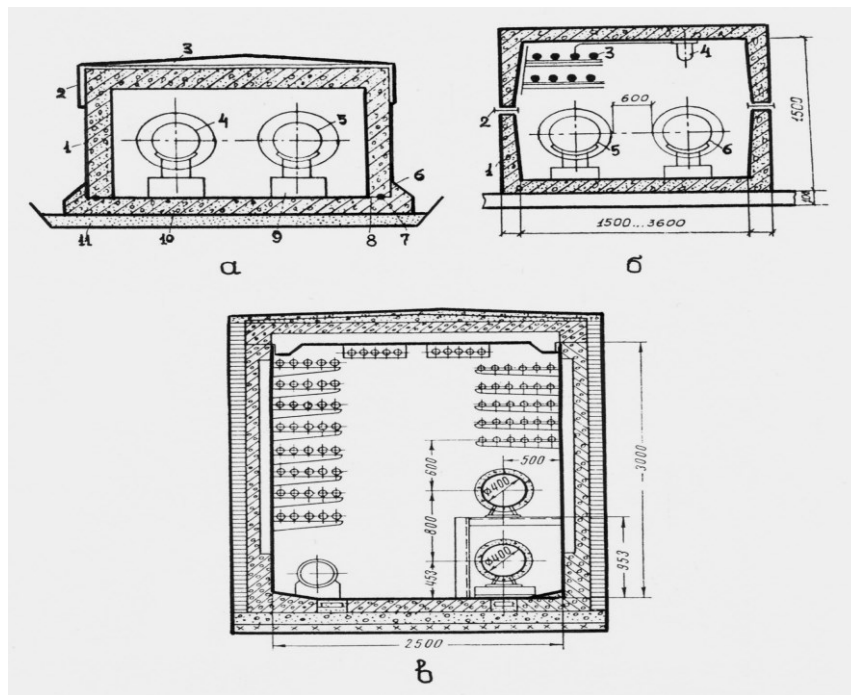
Підземне прокладання теплопроводів: а – у непрохідних каналах: 1 – залізобетонна секція; 2 – гідроізоляція; 3 – захисна стяжка з цементного розчину; 4, 5 – подавальний і зворотний трубопроводи; 6 – бетон; 7 - пароніт; 8 – ізольна мастика; 9 – опорна подушка; 10 – плита; 11 – піщана підготовка або бетон марки 50; б – у напівпрохідних каналах: 1 – залізобетонний лотковий елемент; 2 – двотавр; 3 – низьковольтні кабелі; 4 – світильник; 5, 6 – подавальний і зворотний трубопроводи теплової мережі; в – прокладання теплових мереж у загальному колекторі з іншими міськими інженерними системами
